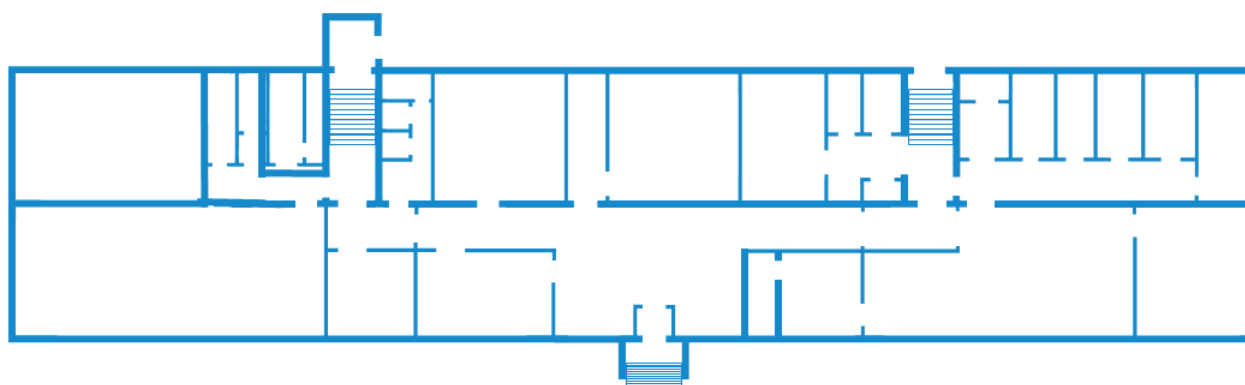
1 этаж, 1-го корпуса лицея
